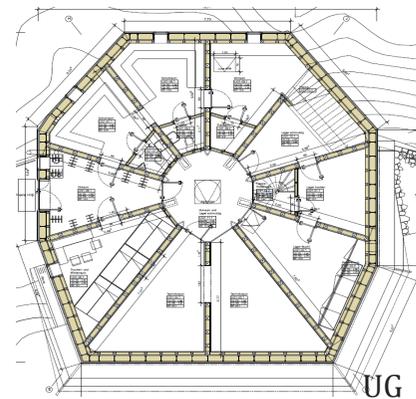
links: Grundriss Untergeschoß und Erdgeschoß
